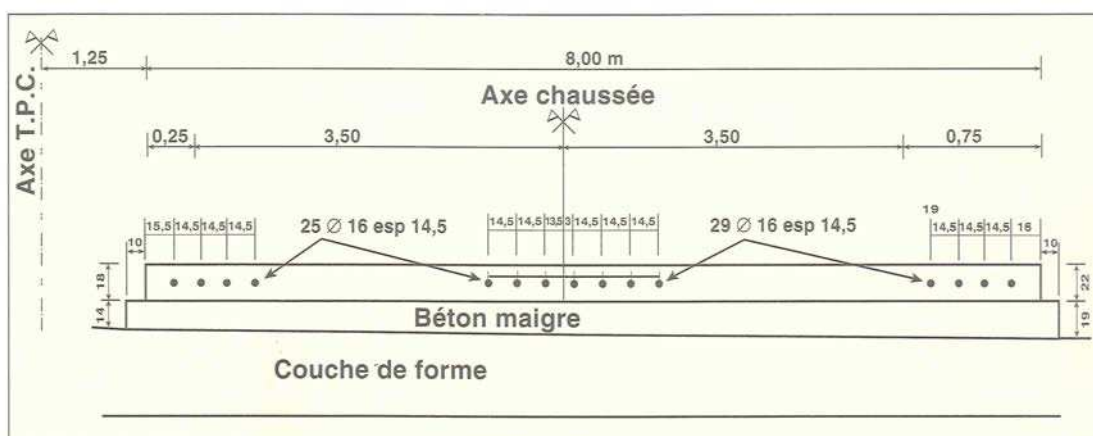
Profil en travers type de la chaussée en béton du contournement de Moulins.
